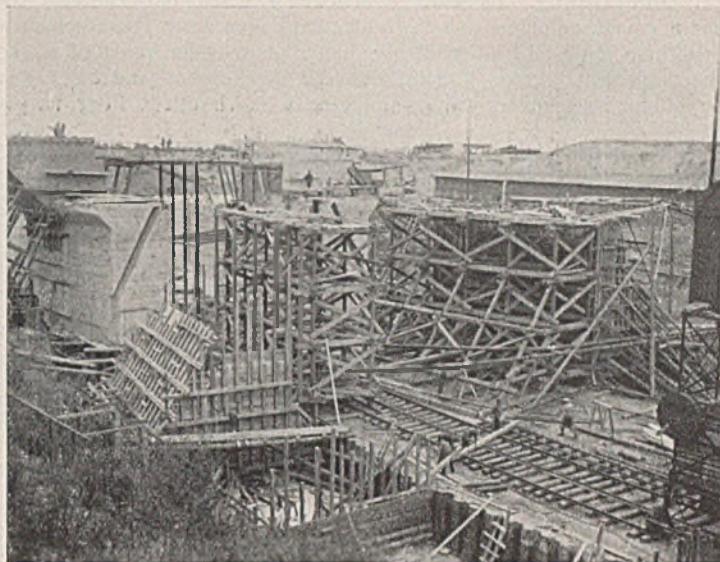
Unterhaupt fertig betoniert. Schalung der Kammerböden.
